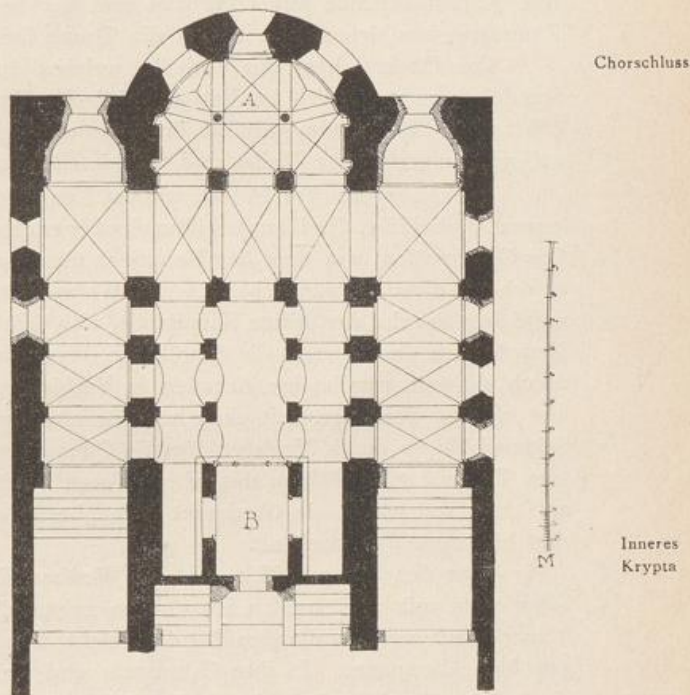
Münster Eifel. Stiftskirche. Grundriss der Krypta.
